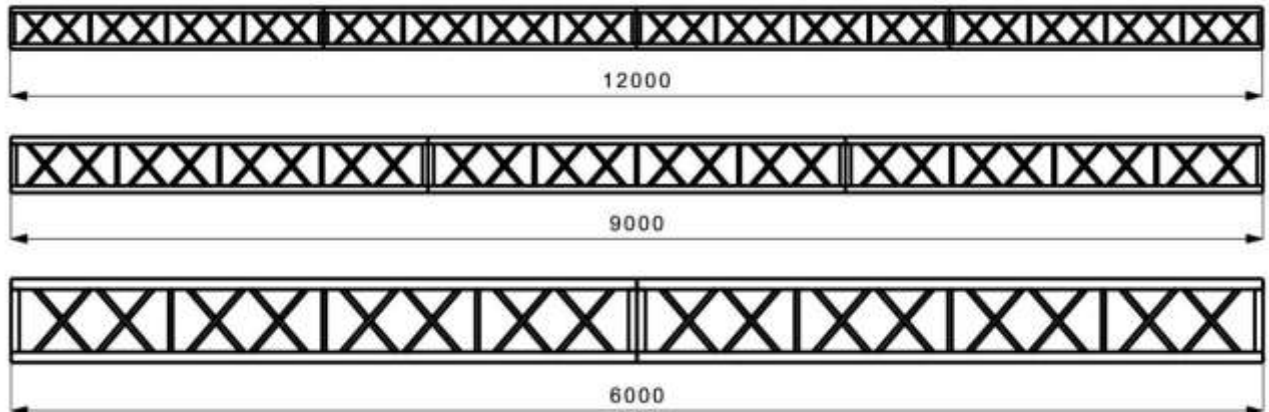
Desde arriba hacia abajo: viga de 12 m obtenida mediante la unión de 4 vigas TR343FE1-00-00; viga de 9 m obtenida mediante la unión de 3 vigas TR343FE1-00-00; viga de 6 m obtenida mediante la unión de 2 vigas TR343FE1-00-00.
